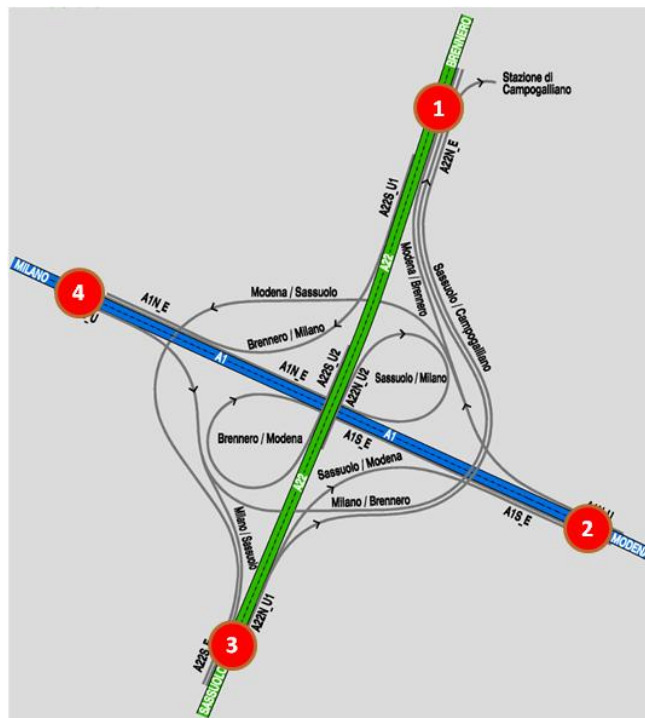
Schema planimetrico del nuovo svincolo A22 – A1
